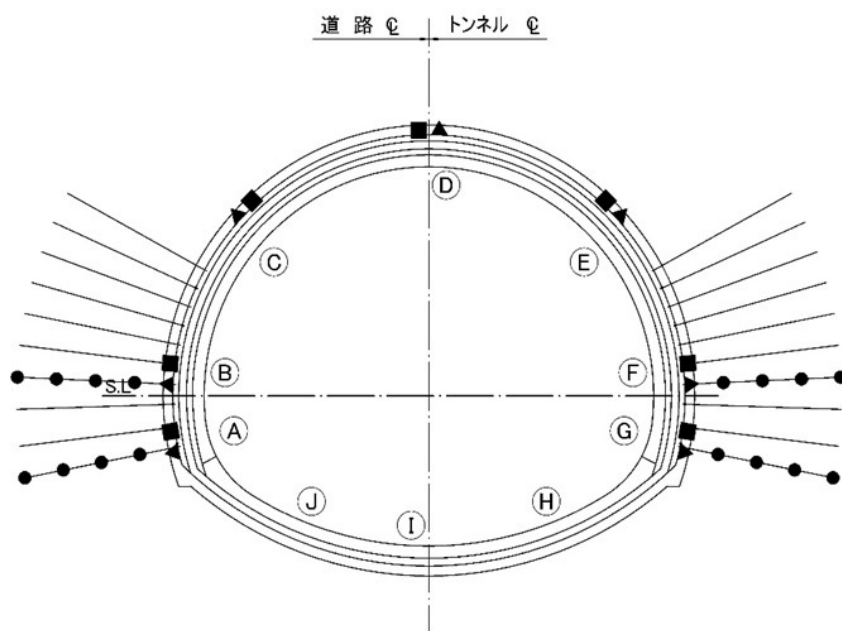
音中トンネル 計測 B 断面図 (P=8, 556)
